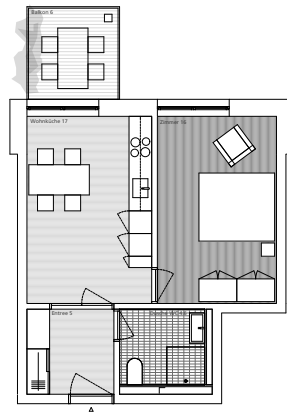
Elmar und Rocky: 2.5-Zimmer Wohnung
